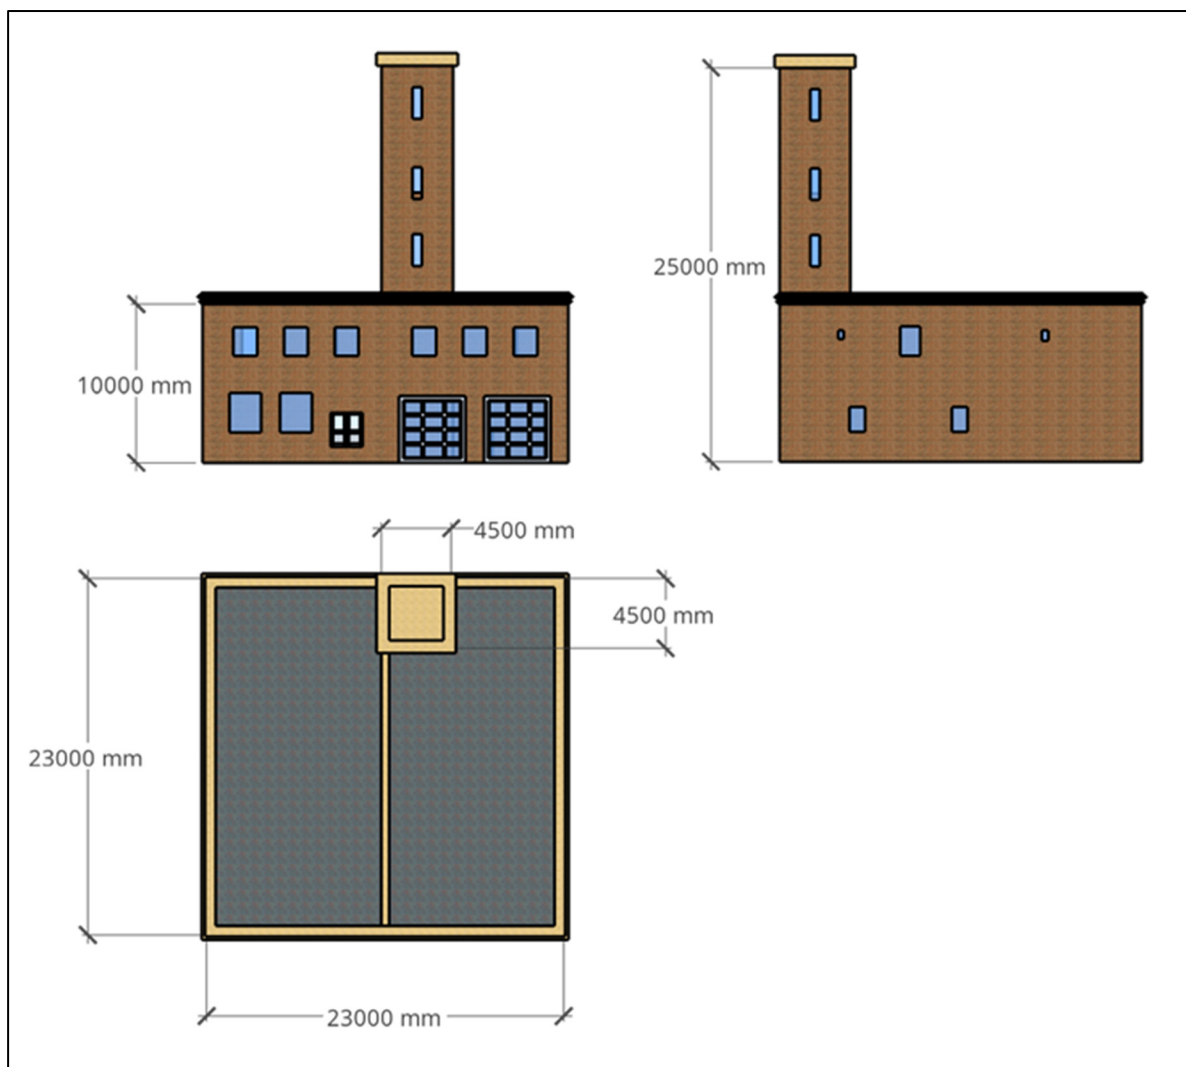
Dimensions caractéristiques des casernes de type 6
